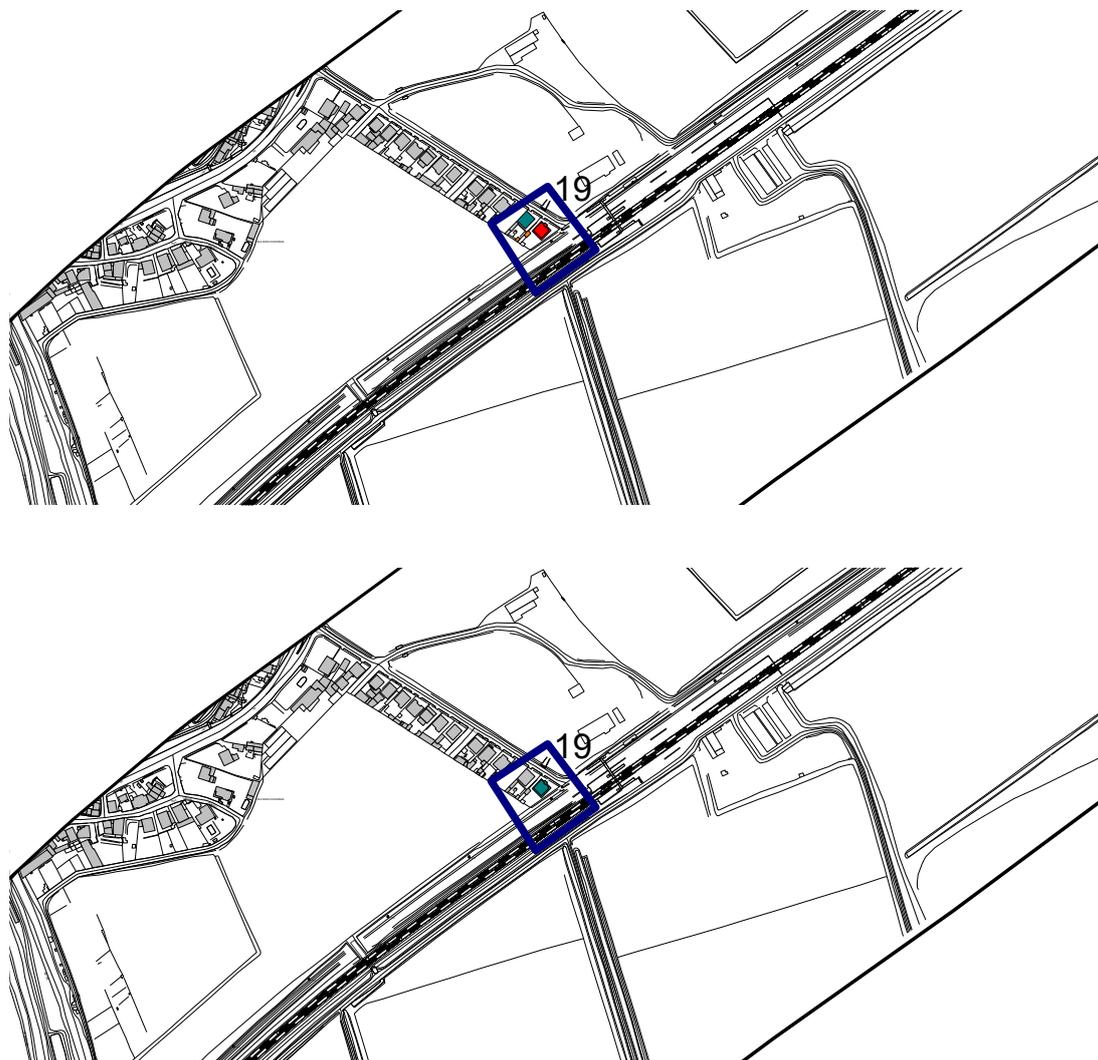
Exposição do edificado ao ruído; Cima: situação existente; Baixo: situação futura – Zona 19 (Vila Nova da Rainha).
